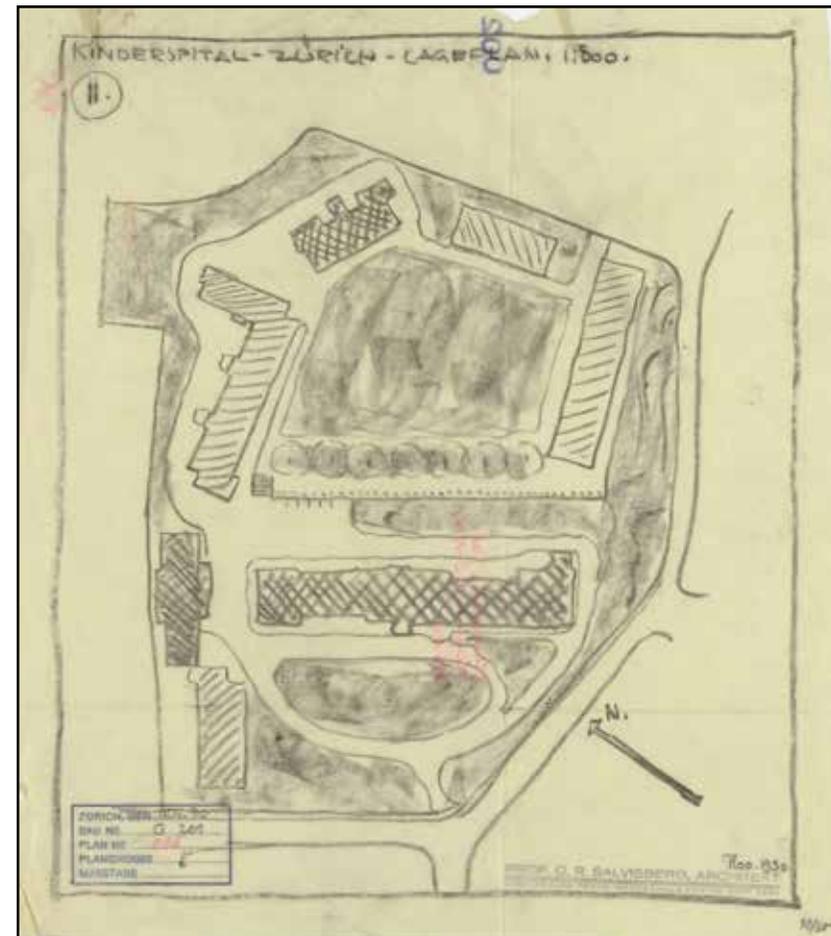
Otto Rudolf Salvisberg: Lageplanskizze, November 1930. Der Gebäudebestand ist dunkler schraffiert.
